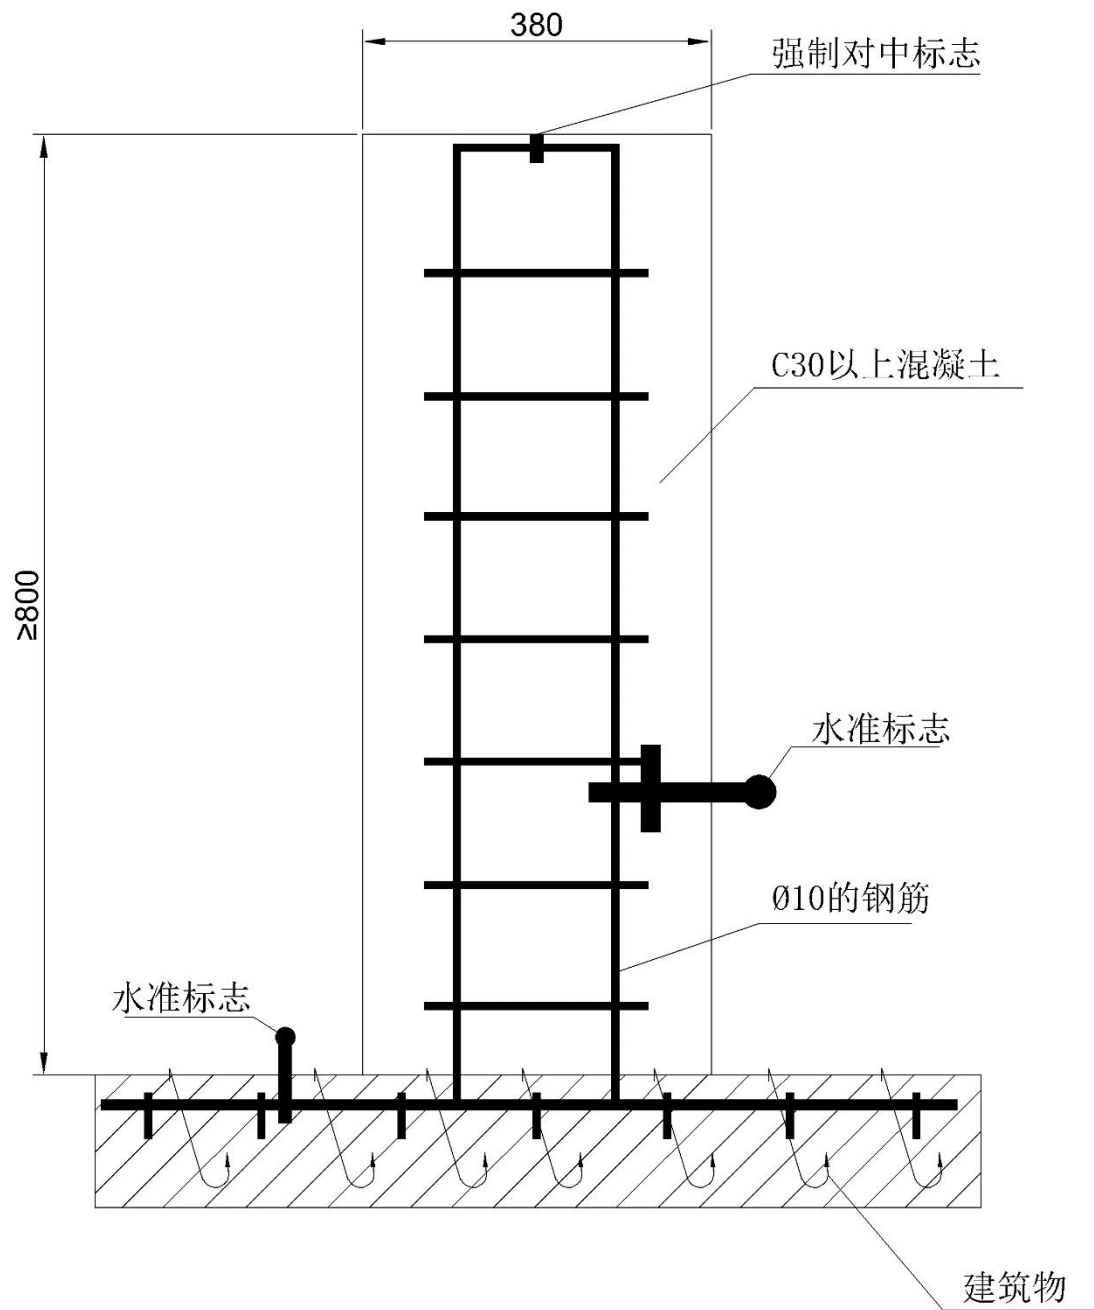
钢筋混凝土屋顶观测墩 (单位:mm)
